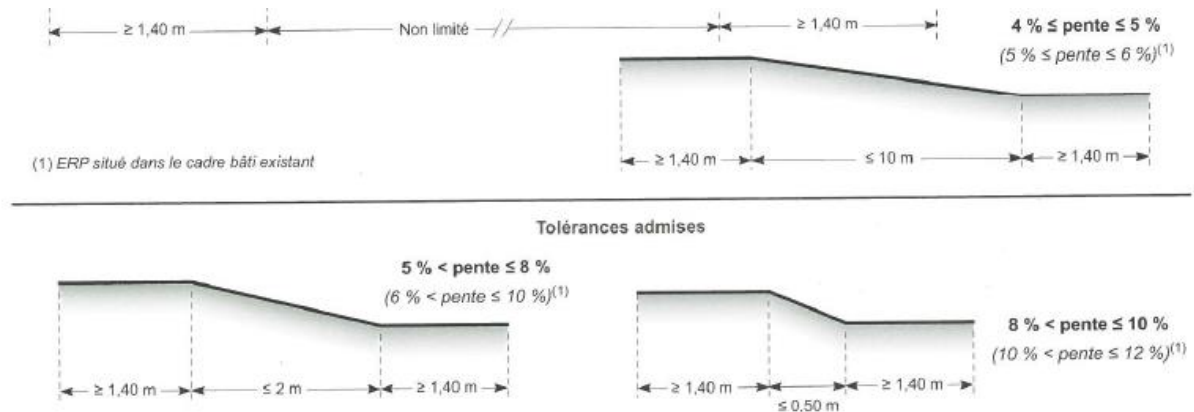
Pentes admissibles pour une rampe d'accès \
